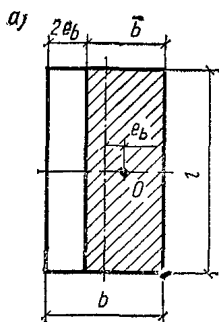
Схема для определения приведенных размеров прямоугольного фундамента
